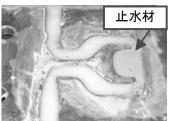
継手部洗浄後状況 写真-6 止水材注入状況
